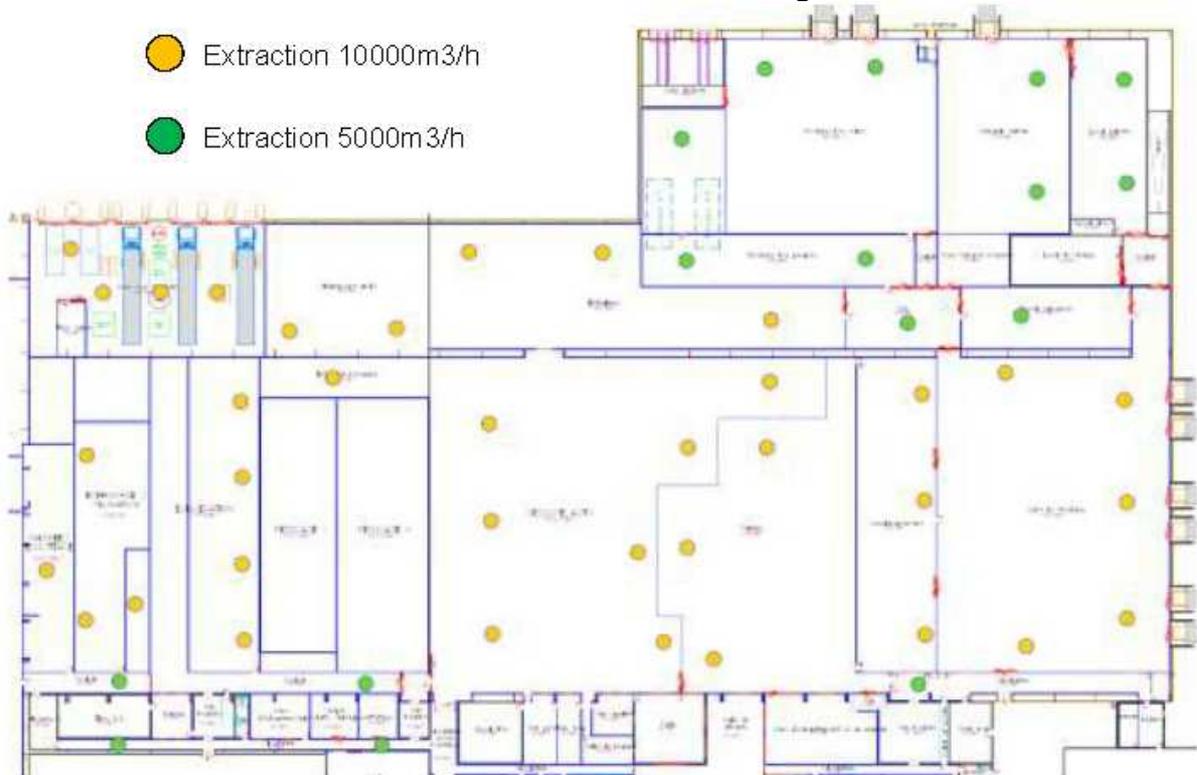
Localisation des extracteurs en toiture sur le site projet SBV CHATEAULIN
